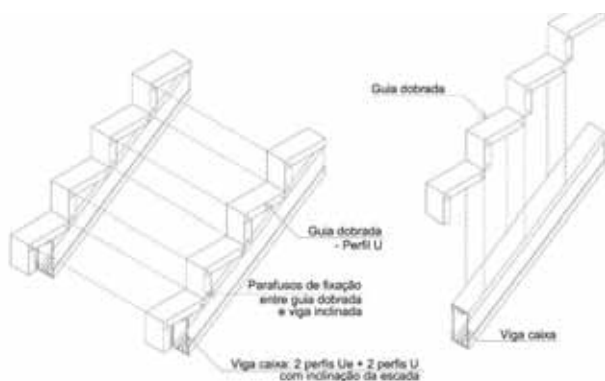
Desenho esquemático de escada viga caixa inclinada
